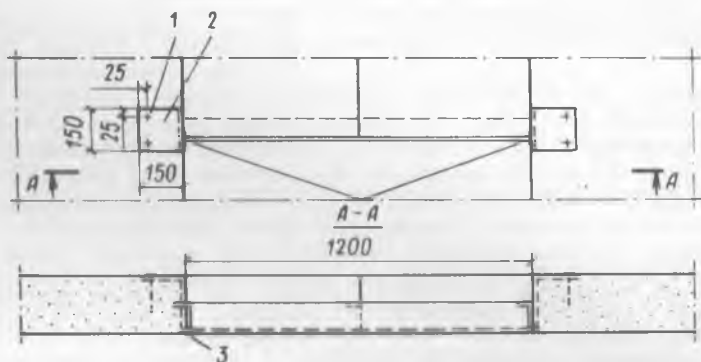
Обрамление плит перекрытия для создания в них проема шириной в две плиты. При этом следует учитывать дополнительную нагрузку на примыкающие плиты (размеры в мм)
